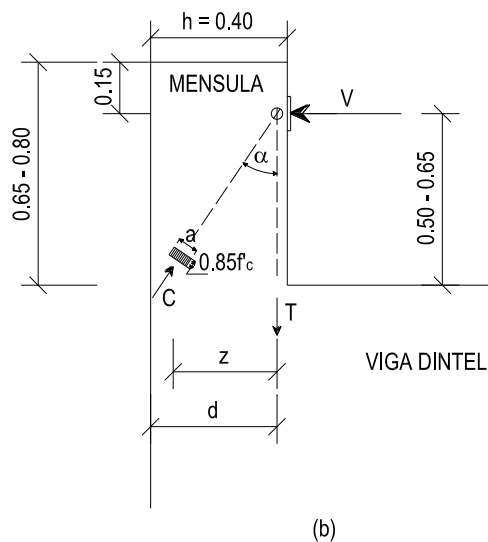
Restricciones de movimiento horizontal. Ménsulas de hormigón en pilas.
